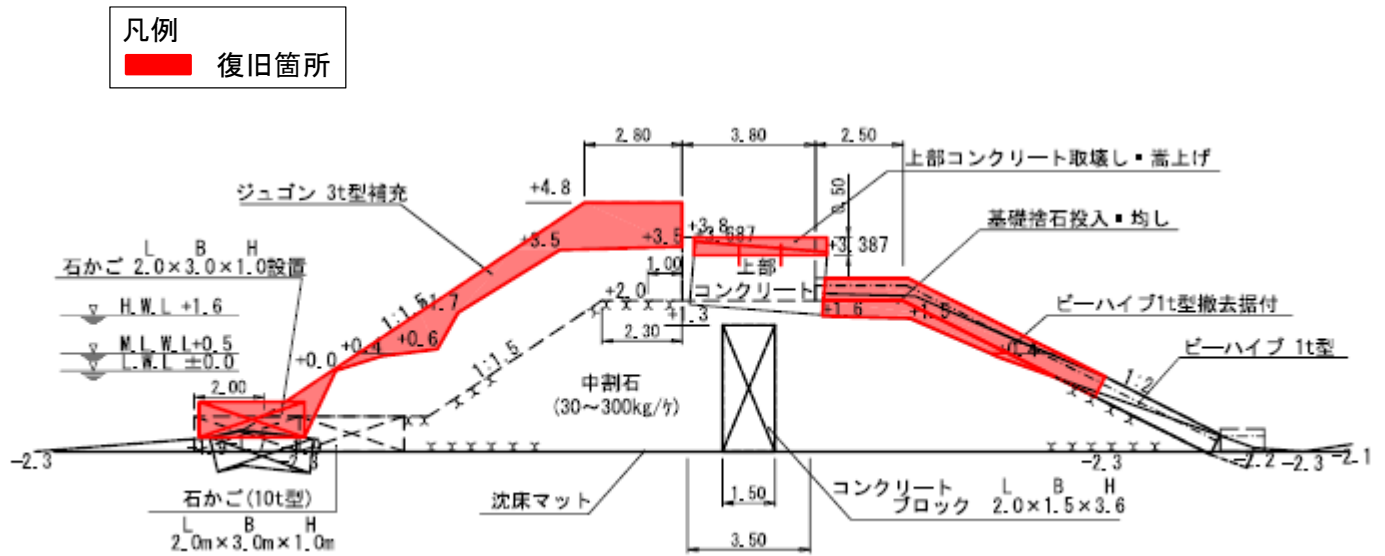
No.2 防波堤(西)の断面図 a1-a1' (復旧後)
